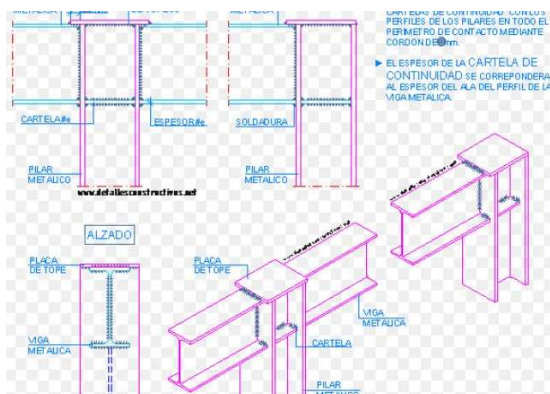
Cruce de vigas IPE mas soldadura.
